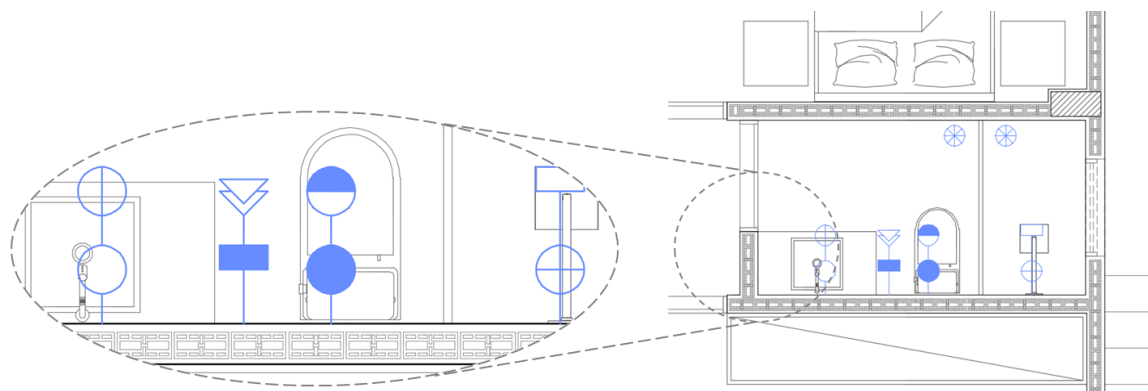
Planta baixa de pontos hidráulicos com ampliação.
